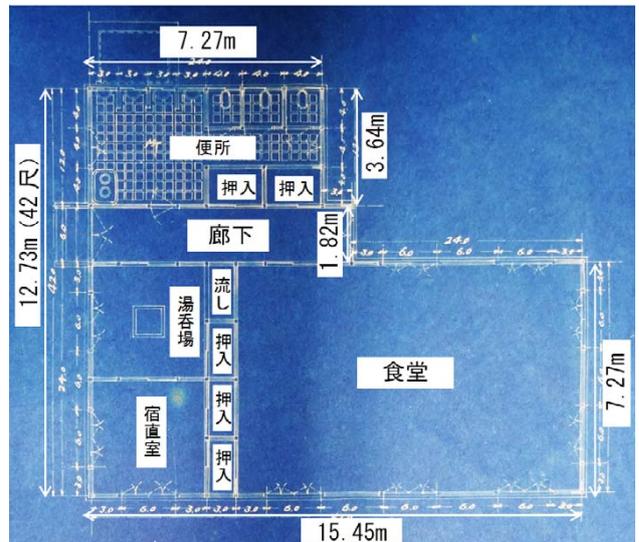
足尾鉱業所の食堂の平面図<sup>54)</sup>
